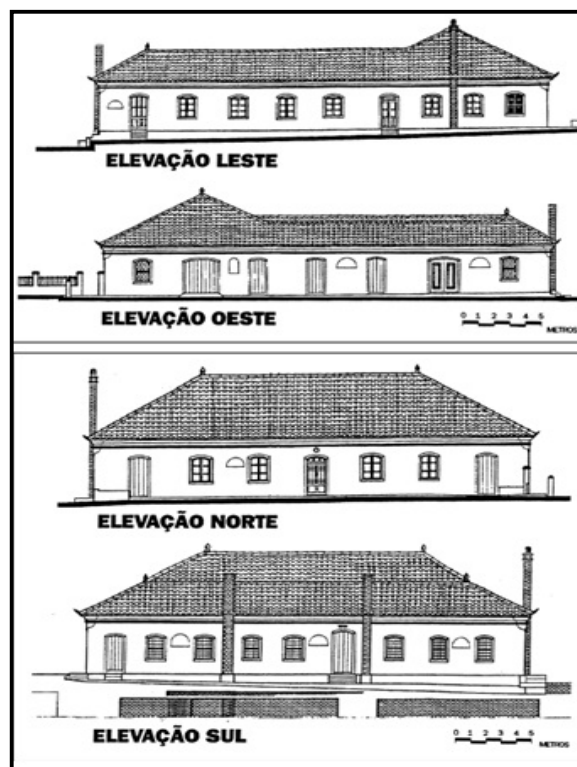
Demonstração das aberturas da Casa Grande da charqueada São João, sentidos norte/sul, leste/oeste. Fonte: GUTIERREZ (2001, p.200)
